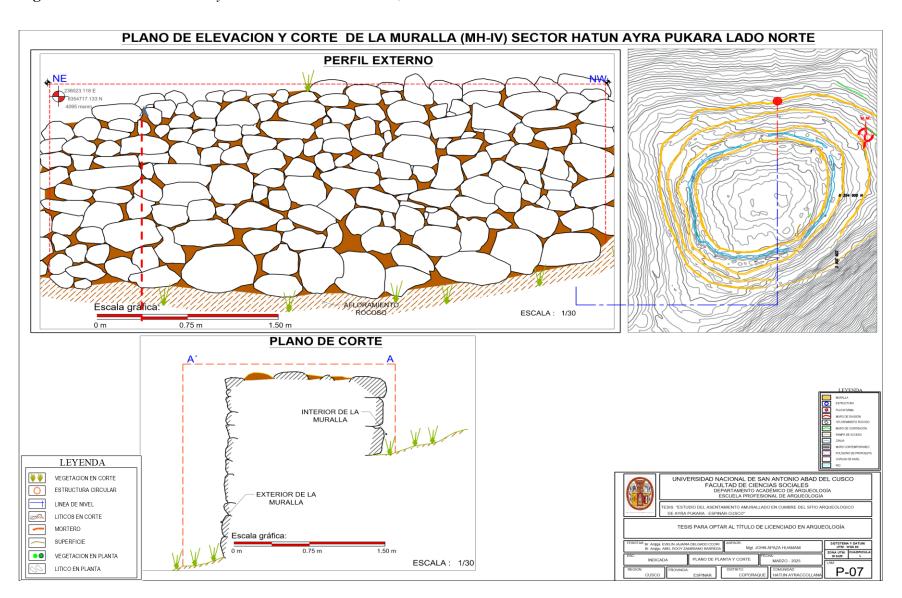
Plano de corte y elevación de la muralla IV, lado Norte
